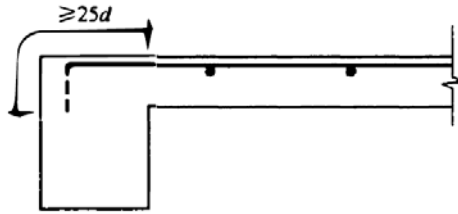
板上部钢筋焊接网与边跨混凝土梁的连接
